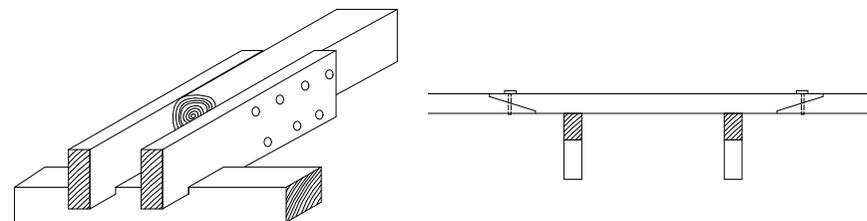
| Sanierung beschädigter Holzverbindungen
